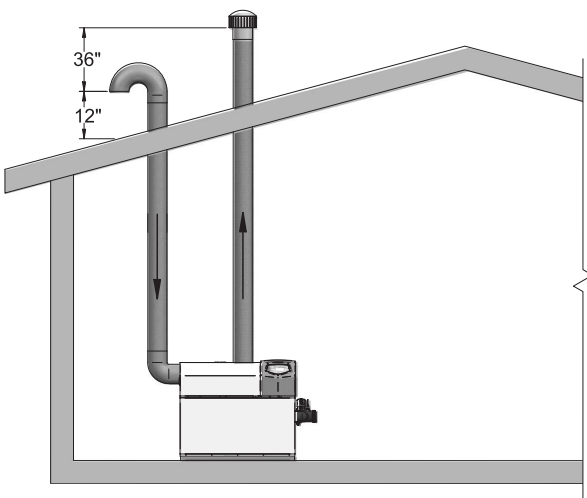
Ventilation DirectAire verticale avec entrée d'air verticale - Voir page 20 pour davantage de détails
